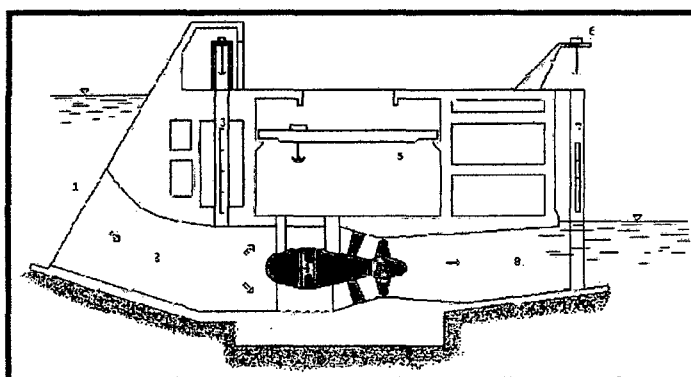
Casa de Máquinas de una central de elevado caudal y baja caída.
